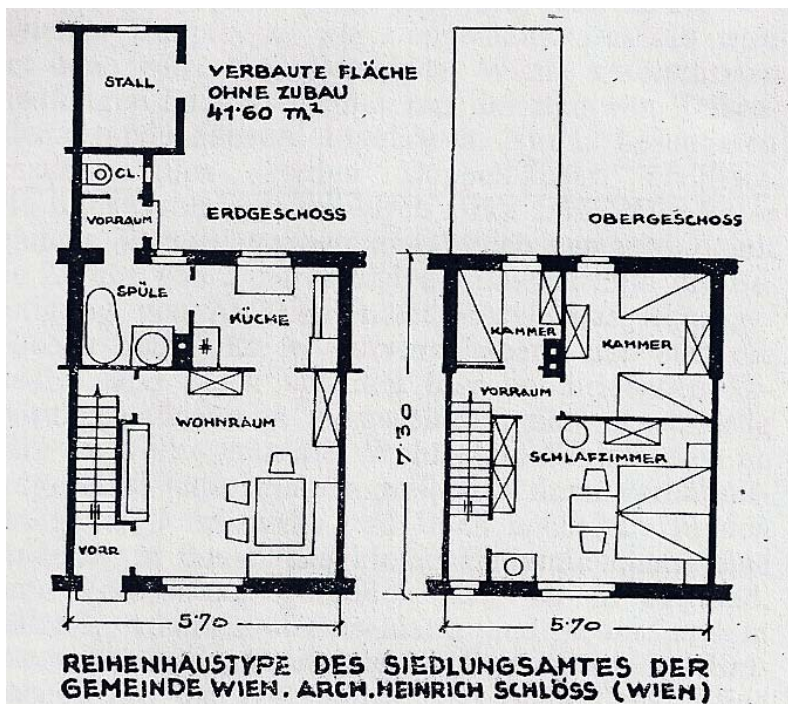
Grundriss eines Siedlungshauses der Zwischenkriegszeit.
